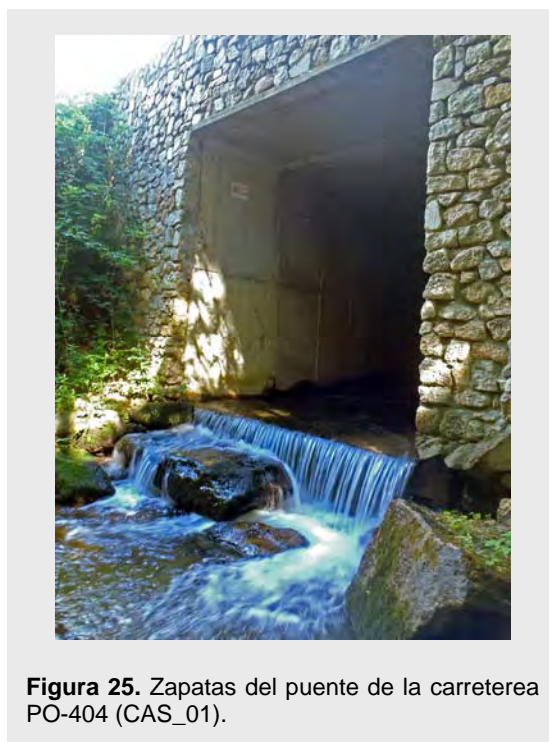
Zapatas del puente de la carretera PO-404 (CAS_01).
